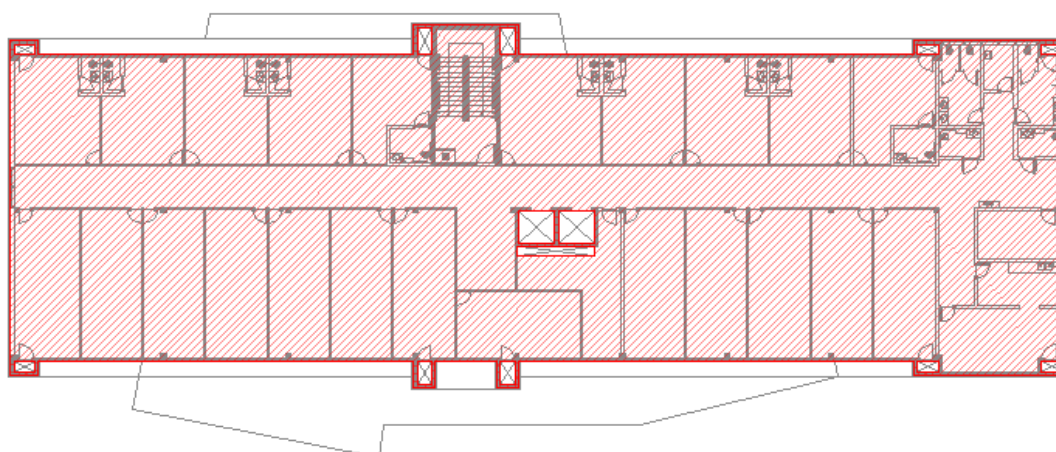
Área considerada para pavimento tipo (3º Pavimento)
